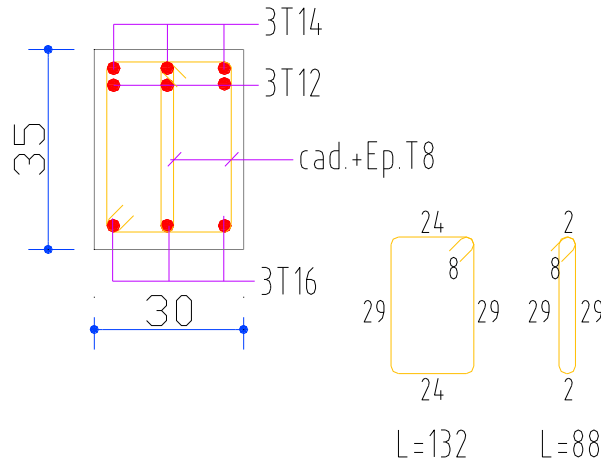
Ferrailage des poutres secondaires au niveau d'appui de 1^{er} à 3^{ème} et de 8^{ème} à 13^{ème} étage.
